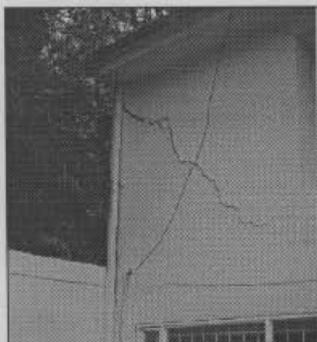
Inclinación de la placa de entrepiso de primer piso
